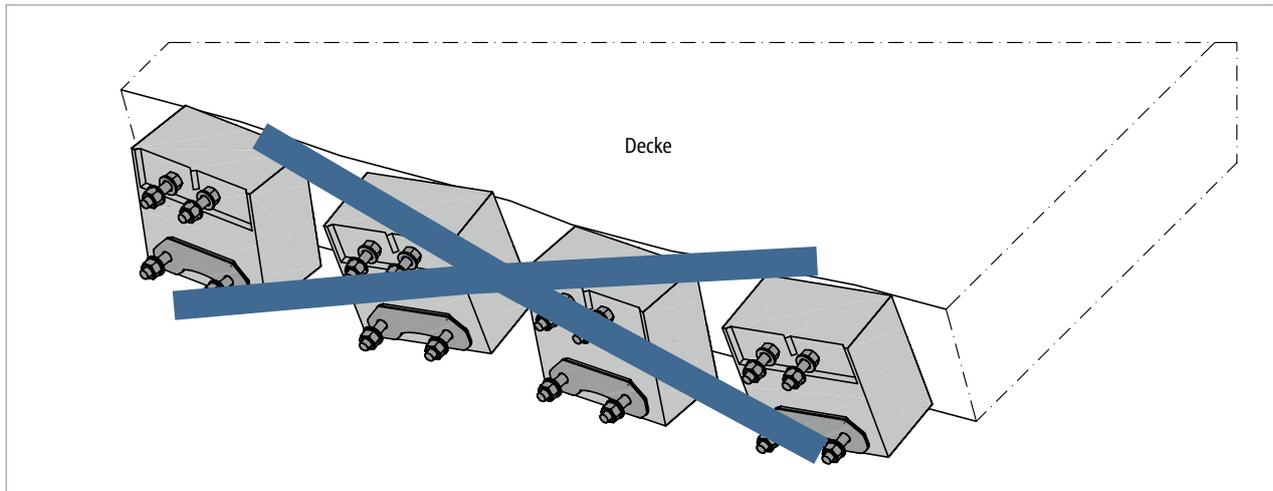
Schöck Isokorb®: Verdrehte und verschobene Elemente durch mangelhafte Lagesicherung während des Betonierens
